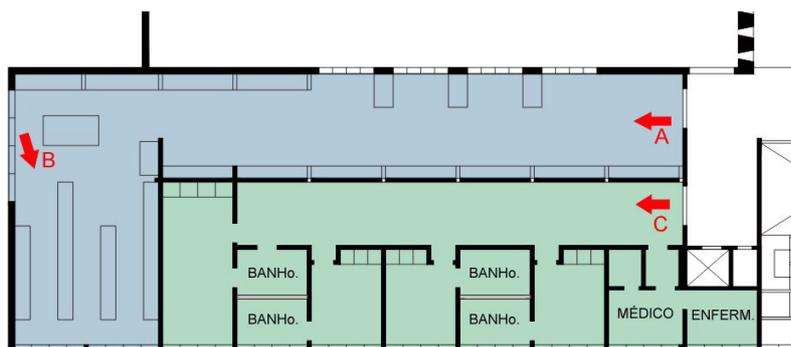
Planta do Primeiro Pavimento do Bloco 5: Enfermaria (em verde) e Biblioteca (em azul). Obra construída. (Desenho da autora).
